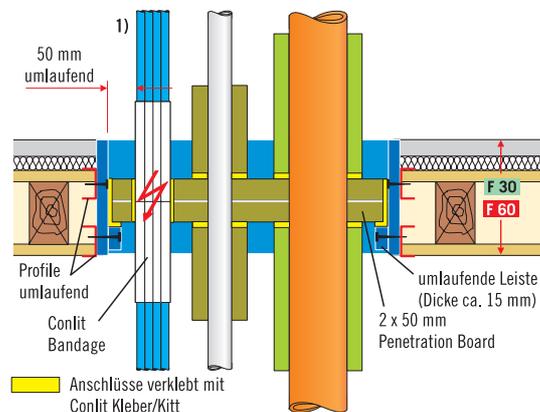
Beispiel zur Abschottung in einer F 30- bis F 60-Holzbalkendecke (gilt für die Gesamtkonstruktion) mit Rockwool Penetration Board
